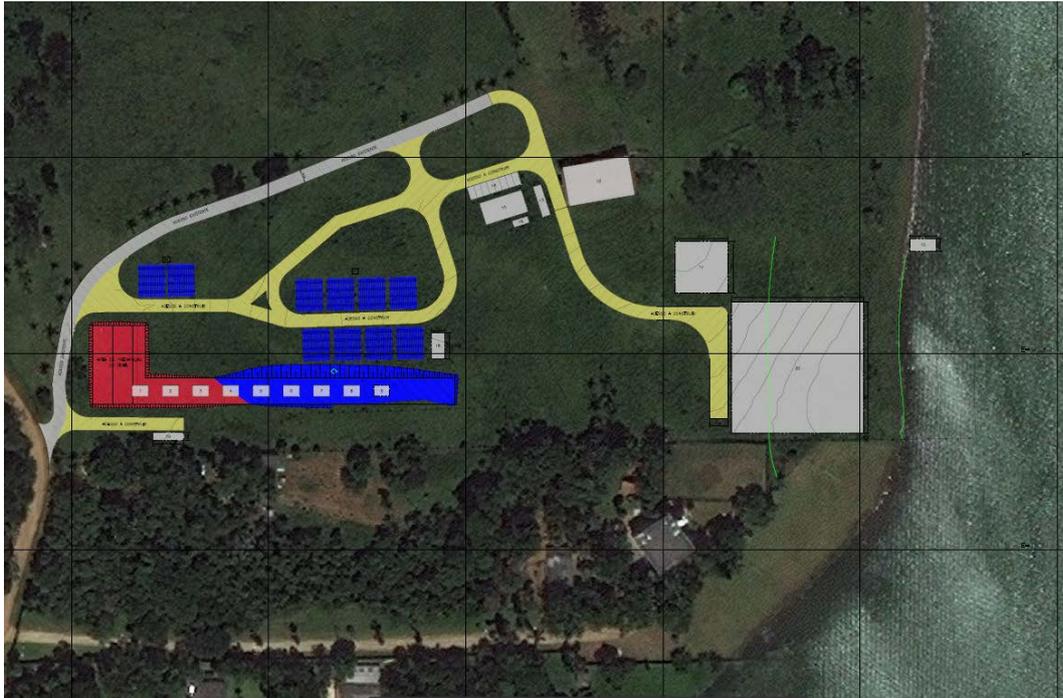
Arranjo típico de para canteiro e área de apoio para implantação de gasoduto.
